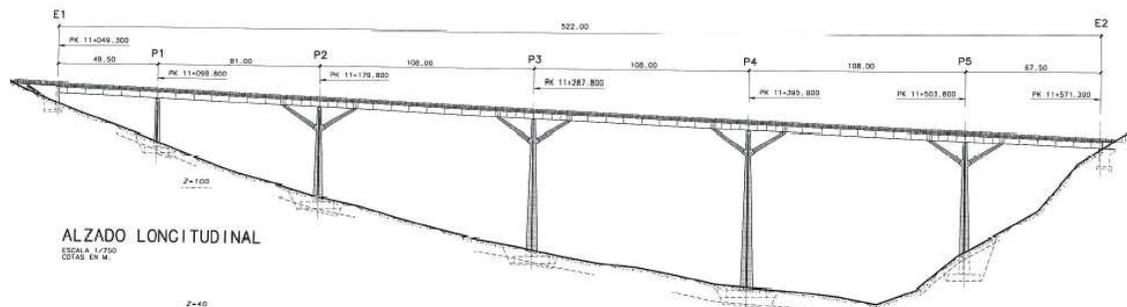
Alzado Longitudinal del Viaducto del Risco
